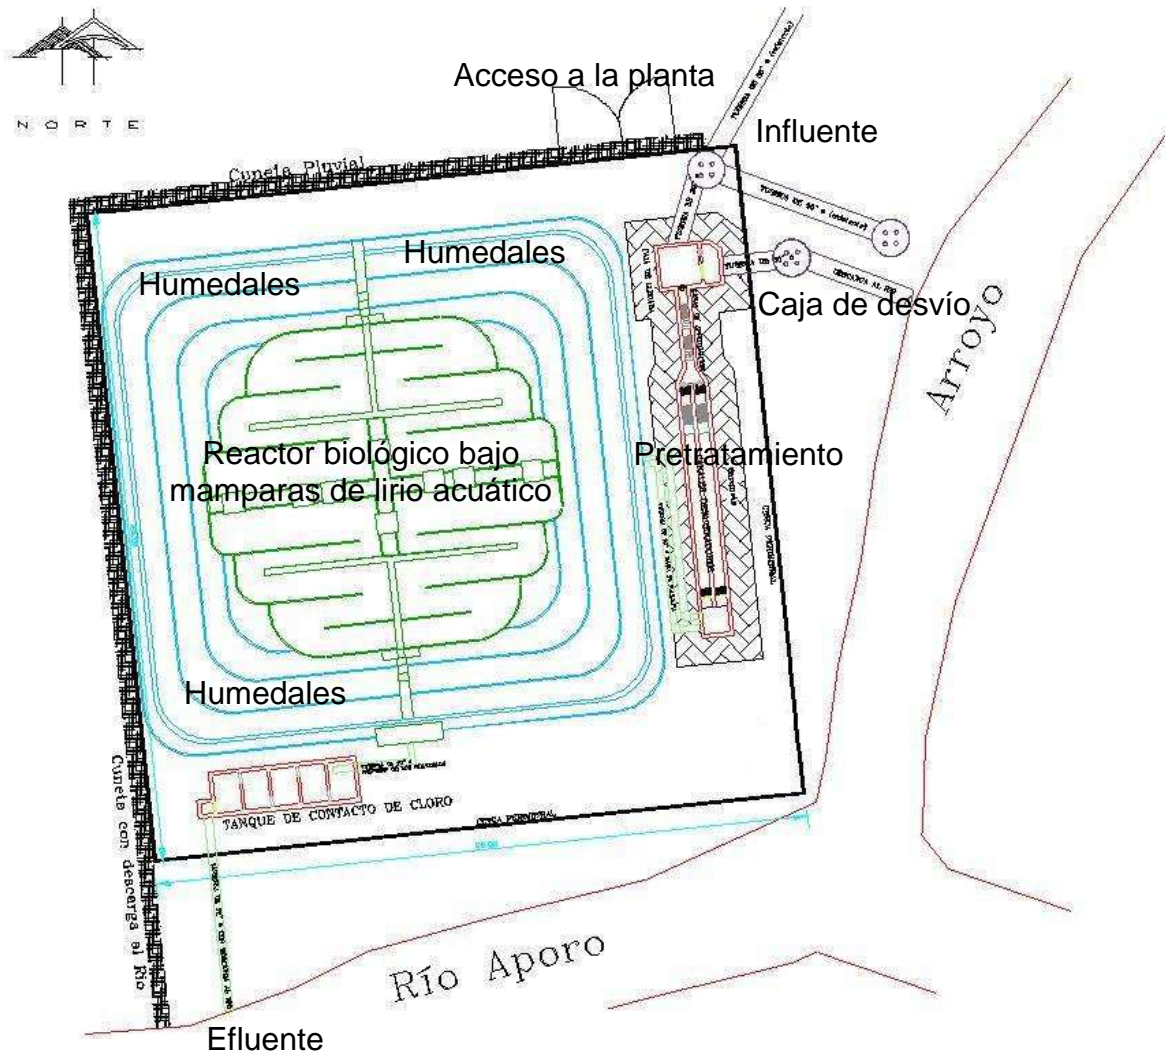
Planta de arreglo de conjunto de proyecto, con las estructuras de rehabilitación y el tanque de contacto de cloro.
